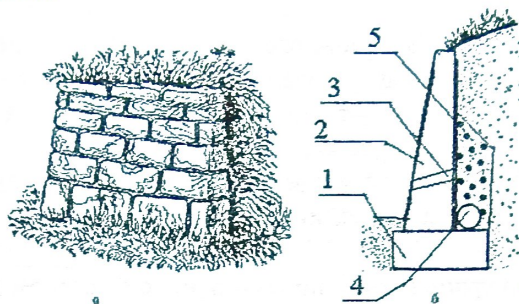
Подпорная стенка: а – общий вид подпорной стенки; б – разрез подпорной стенки, 1 – фундамент; 2 – тело; 3 – дренажное отверстие; 4 – дренажная труба; 5 – гравий
